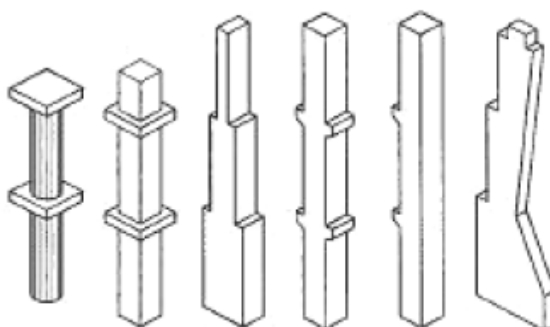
Exemplos tipo de pilares pré-fabricados [8]
